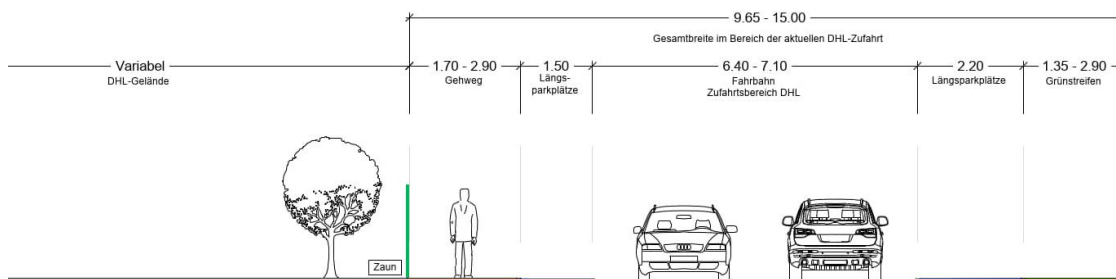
Bestehender Querschnitt Zufahrt DHL-Grundstück
